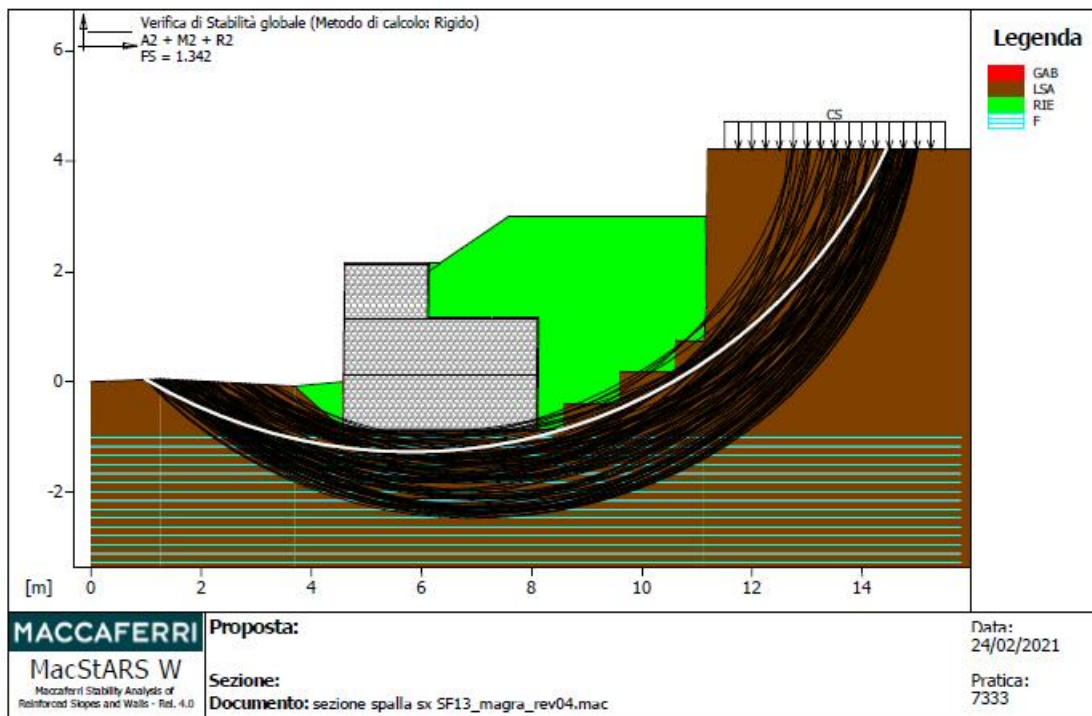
Verifica di stabilità sezione spalla sx- condizione di magra -statica
